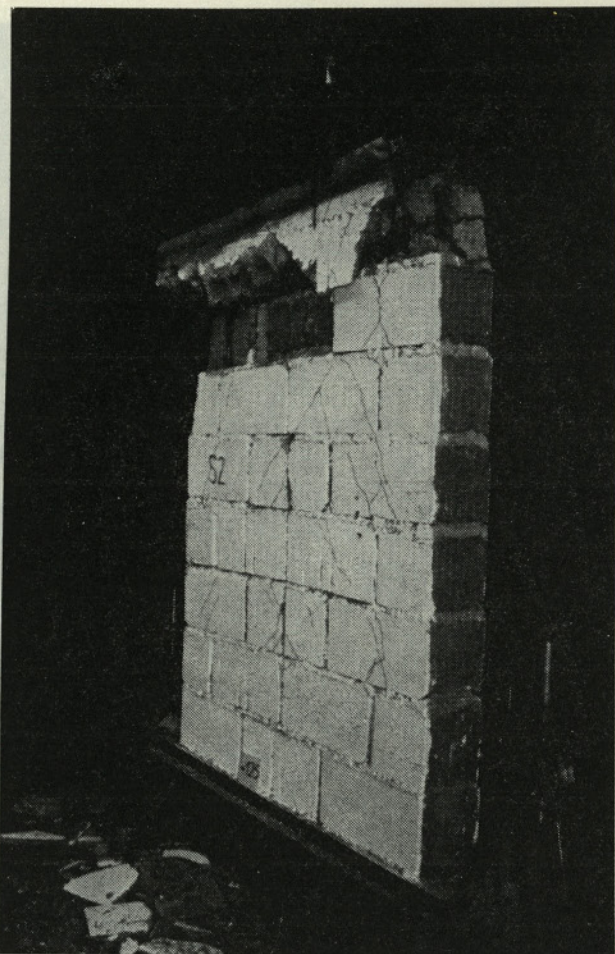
Strižna porušitev upogibno armiranega zidu brez strižne armature
